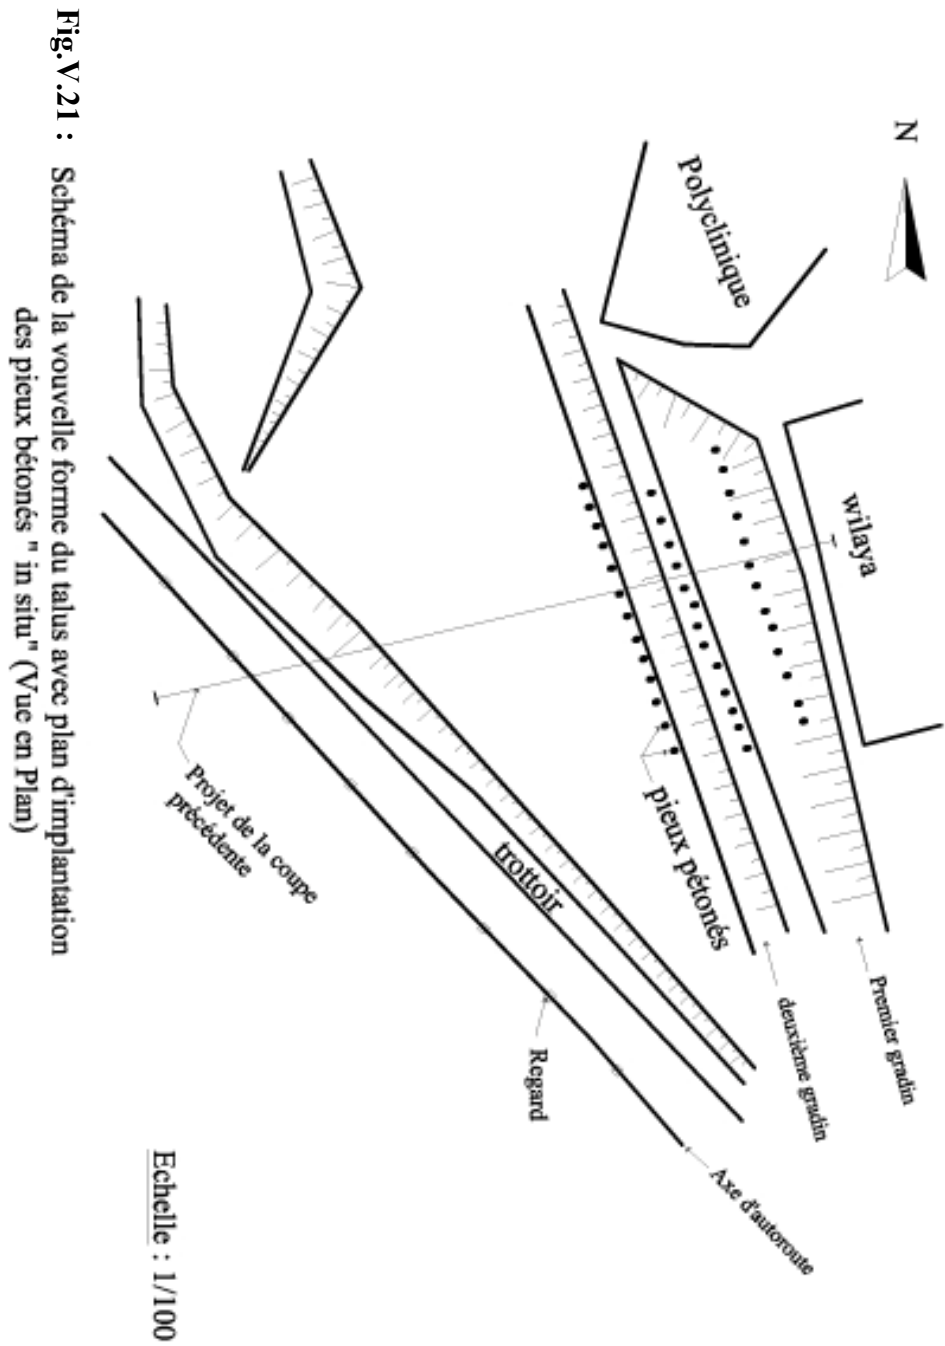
Schéma de la nouvelle forme du talus avec plan d'implantation des pieux bétonés " in situ" (Vue en Plan)
